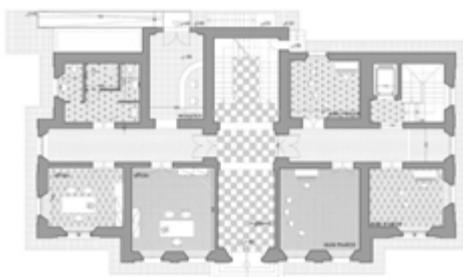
Pianta piano primo di progetto: Al primo piano, il lungo corridoio che percorre tutto l'edificio longitudinalmente, ha acquistato un'illuminazione naturale grazie alla demolizione delle due pareti che si trovavano disposte simmetricamente in fondo al corridoio e che racchiudevano i due servizi. Al primo piano troviamo, oltre ai servizi e al vano ascensore affiancato da una saletta caffè, 2 aule di musica, la biblioteca, la mediateca e una sala ascolto.
